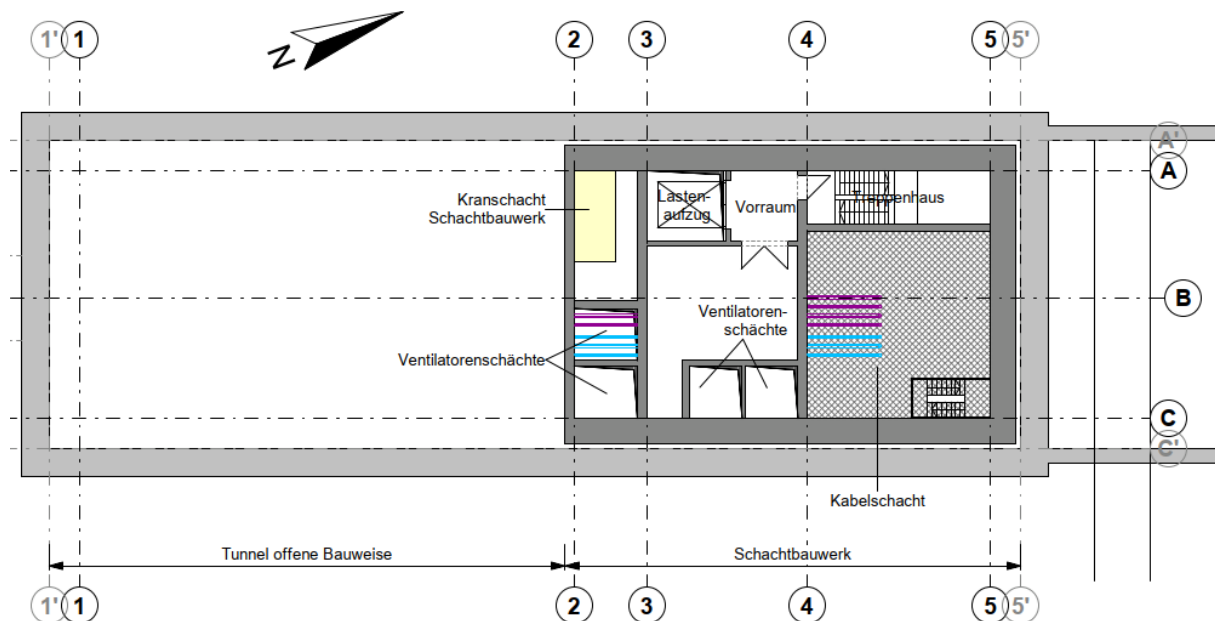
Grundriss Schachtbauwerk SH; 3. Untergeschoss
